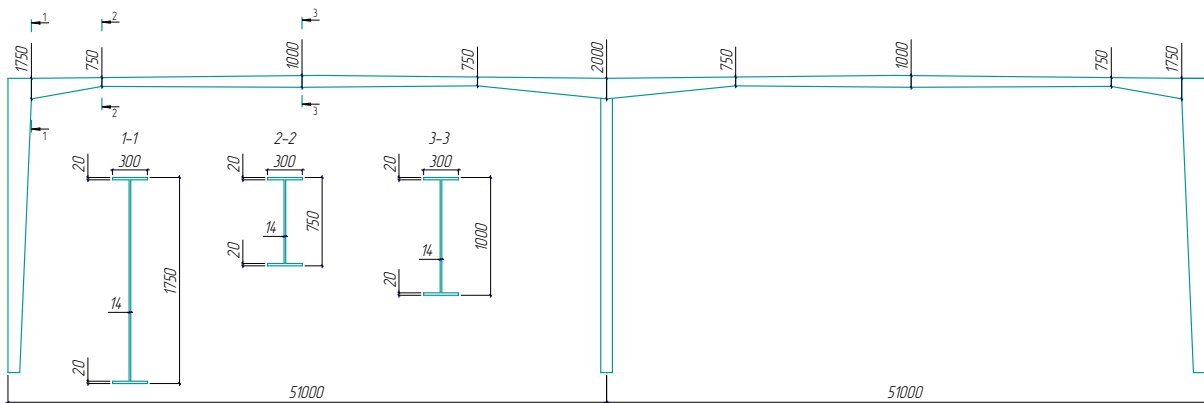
Расчетная схема двухпролетной рамы (вариант 1)
